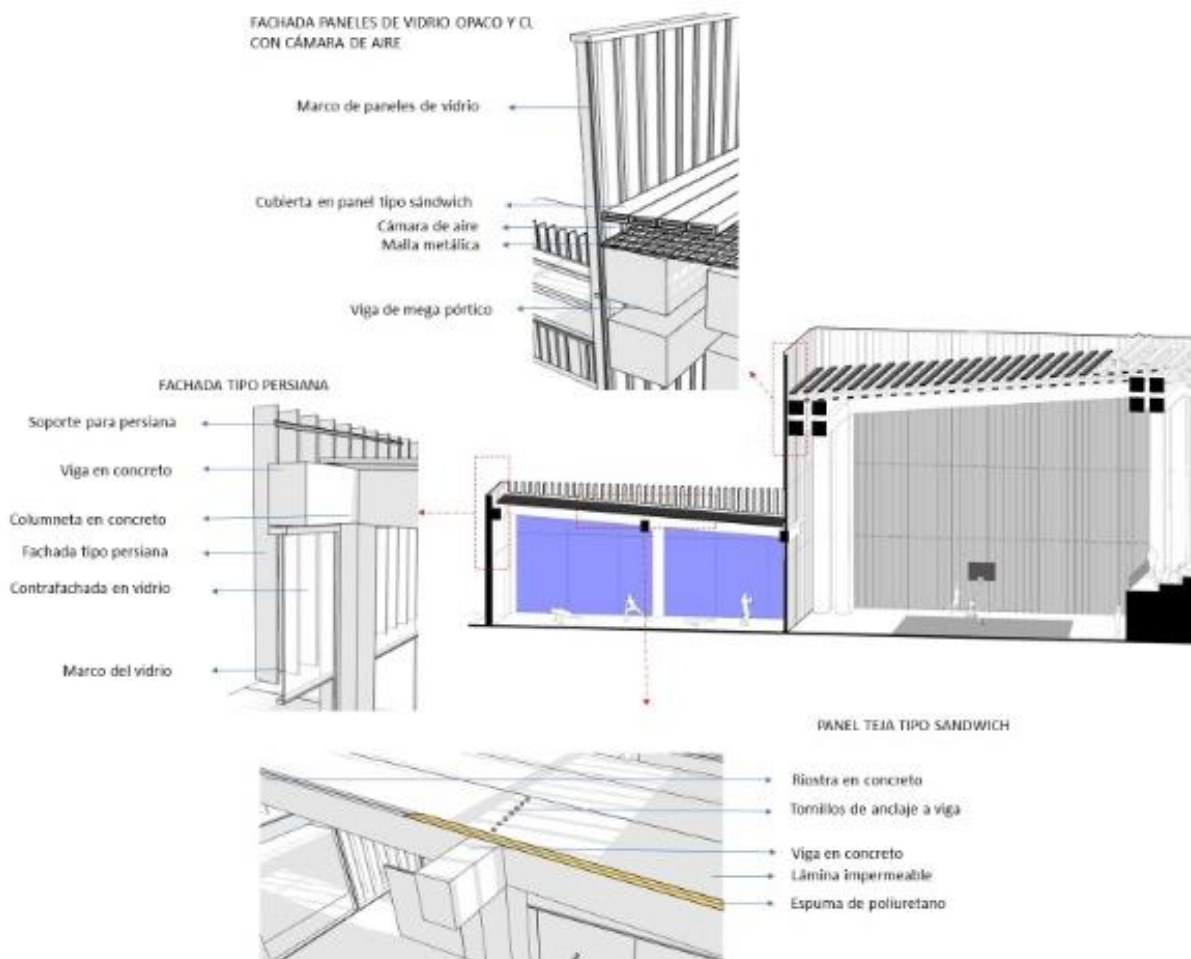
Propuesta de fachada y cubierta CEFE Gibraltar. Propuesta de fachada y cubierta CEFE Gibraltar. Elaboración propia. (2020).
